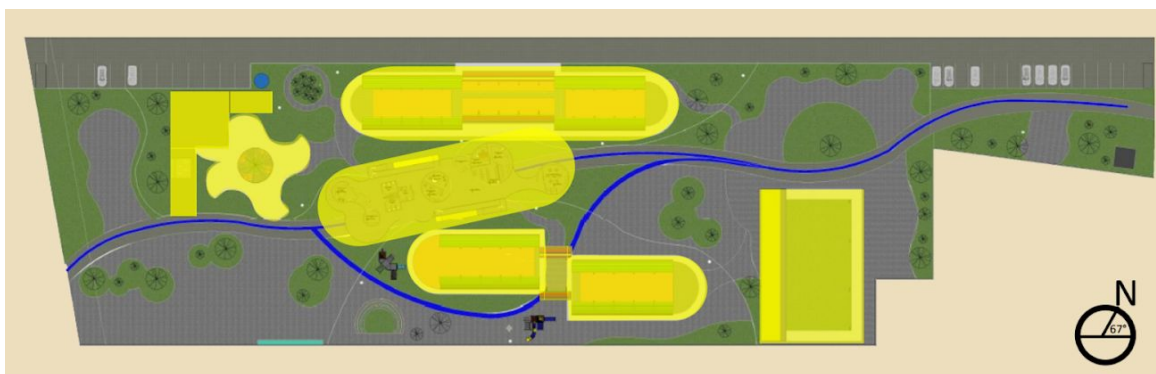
Planta baixa de implantação. Fonte: Elaborado pelos autores.
